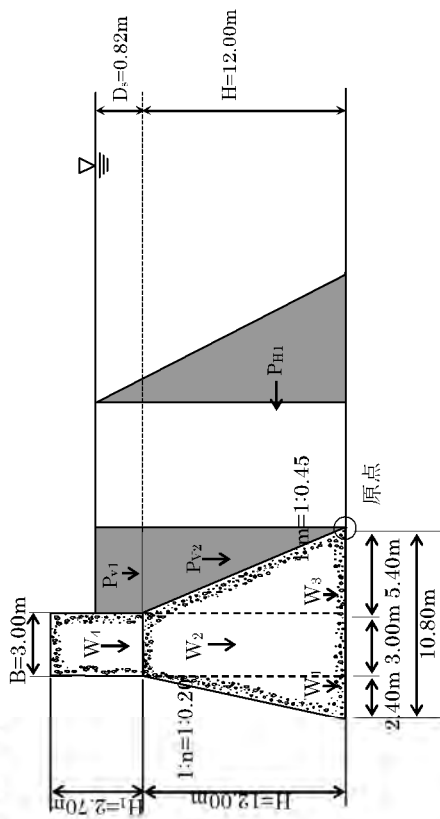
砂防堰堤に作用する力 (断面 (2) : 洪水時)
